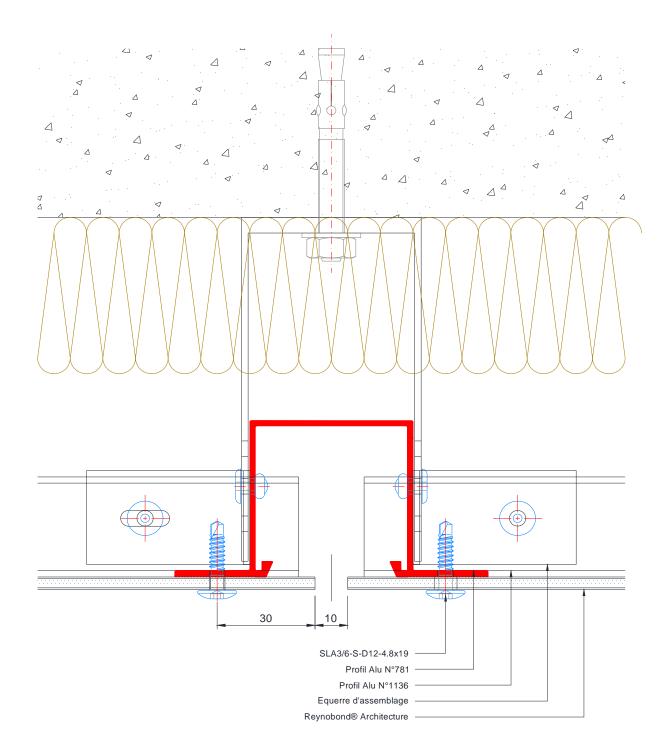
is – Joint vertical - Coupe horizontale - Système vissé SC 50 4c
